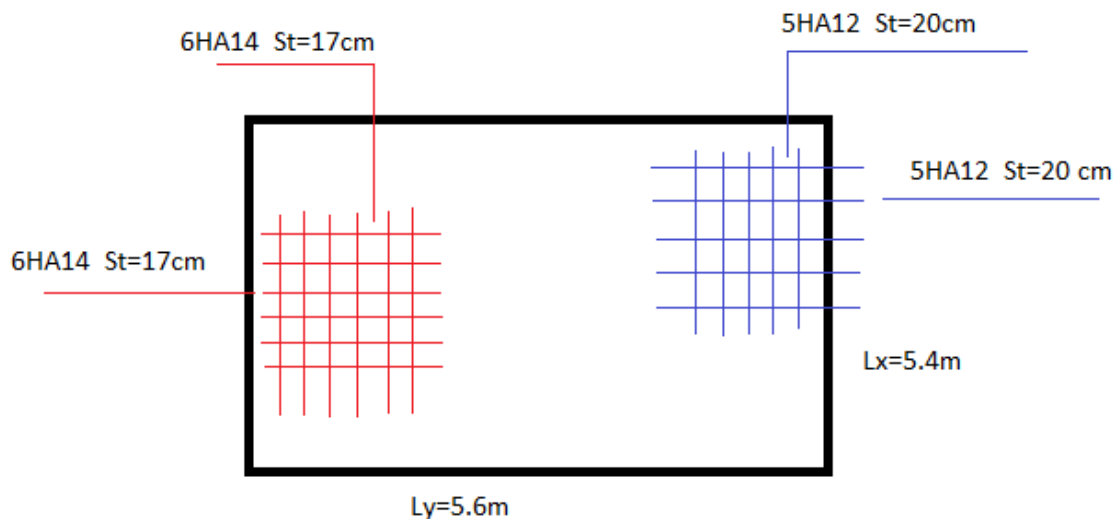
Schéma de ferrailage du voile Périphérique.
